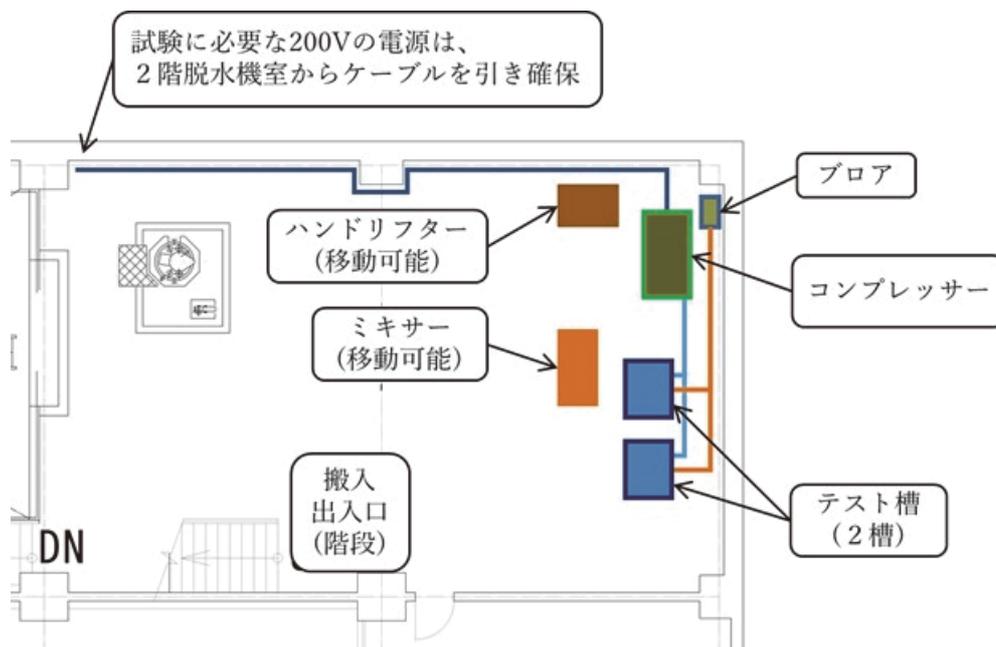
試験装置類配置図 (焼却棟1、2系焼却施設薬品貯蔵庫)
